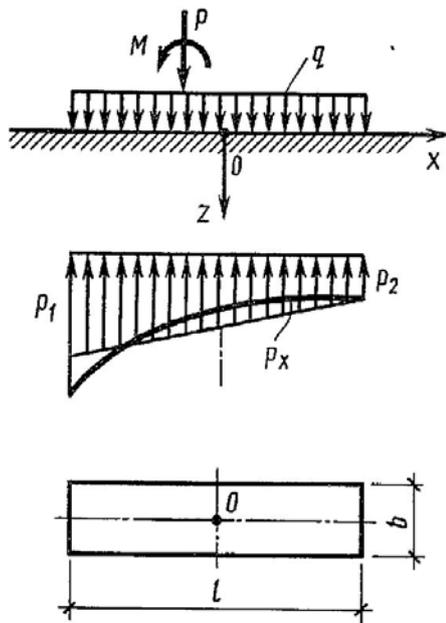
Предварительный подбор сечения фундаментной балки
